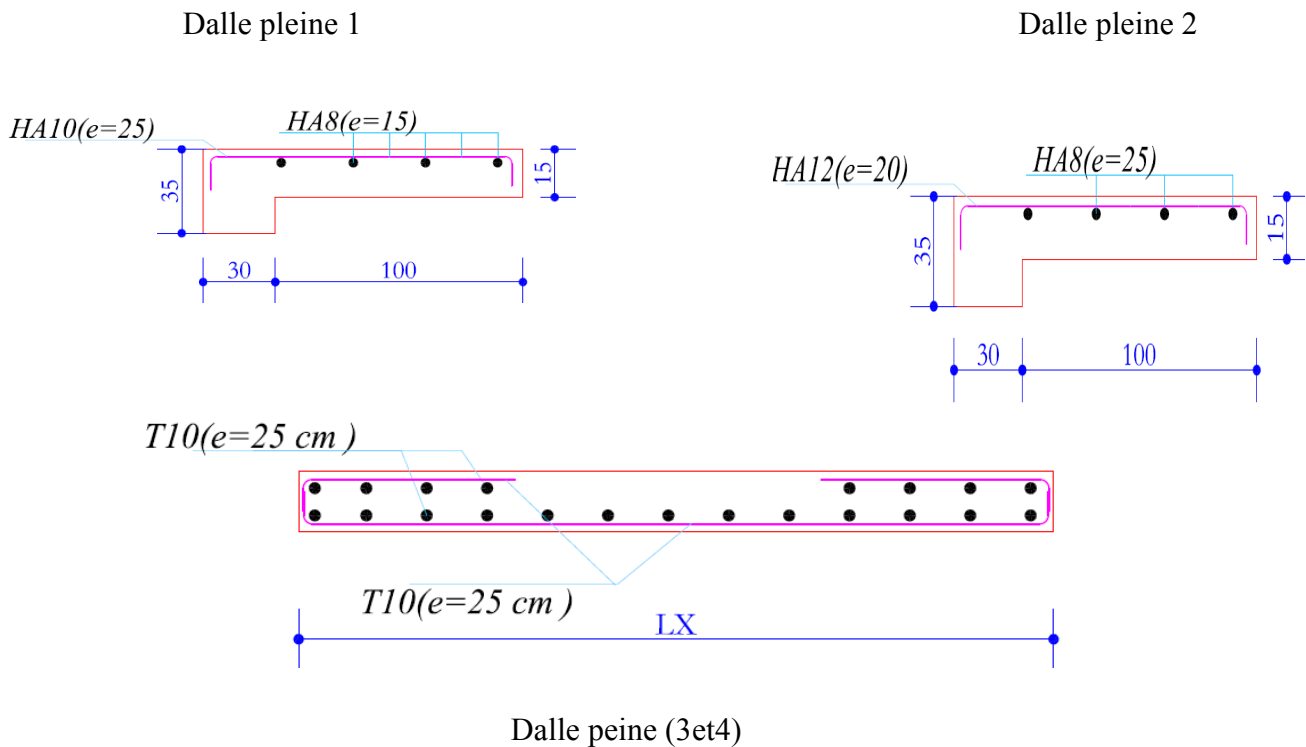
schéma de ferrailage des dalles pleines dans les différents étages
